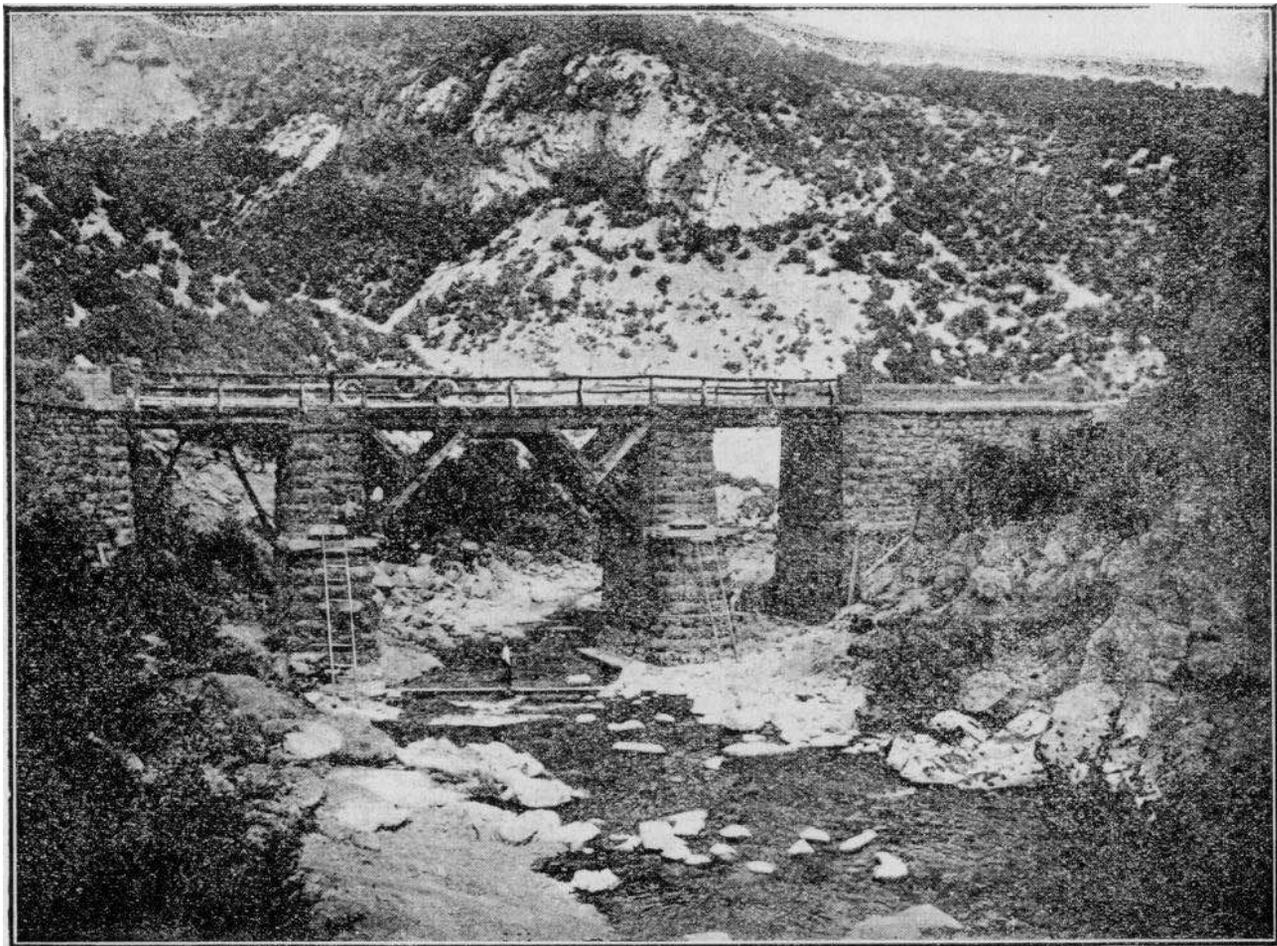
Puente en la carretera de Aoiz a Burguete, (Reconstruido en 1923).
